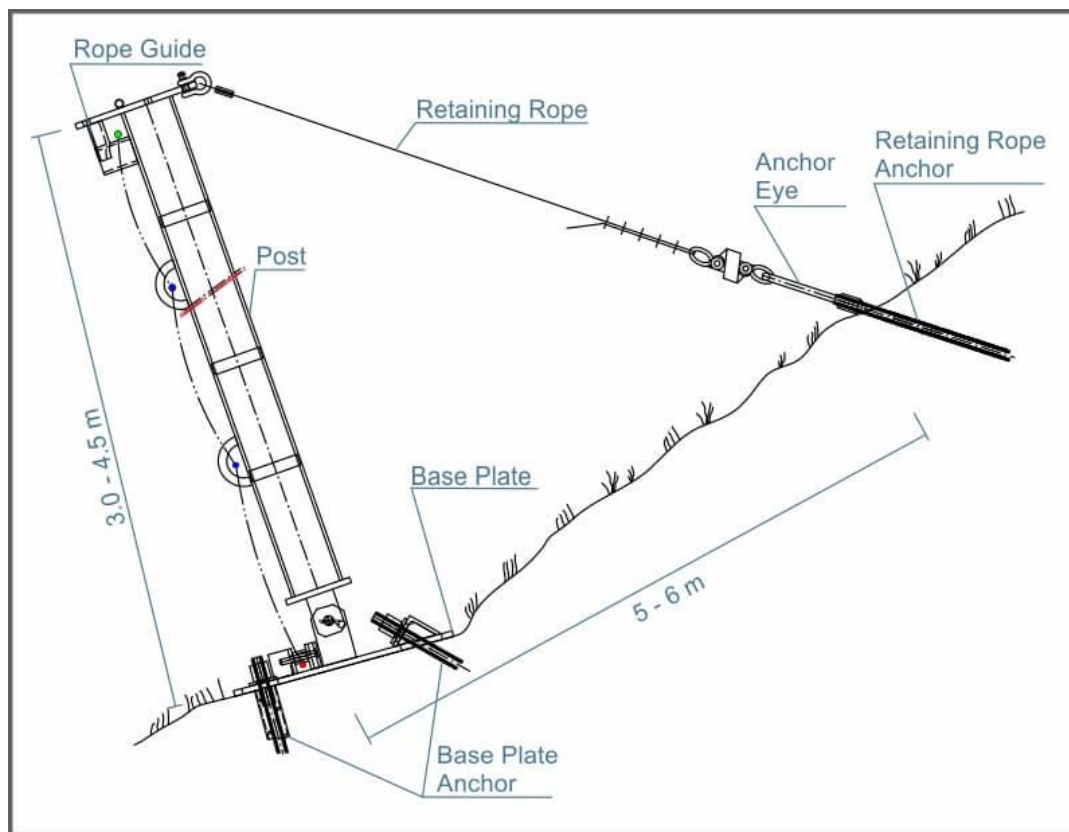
SEZIONE TRASVERSALE DELLA BARRIERA
